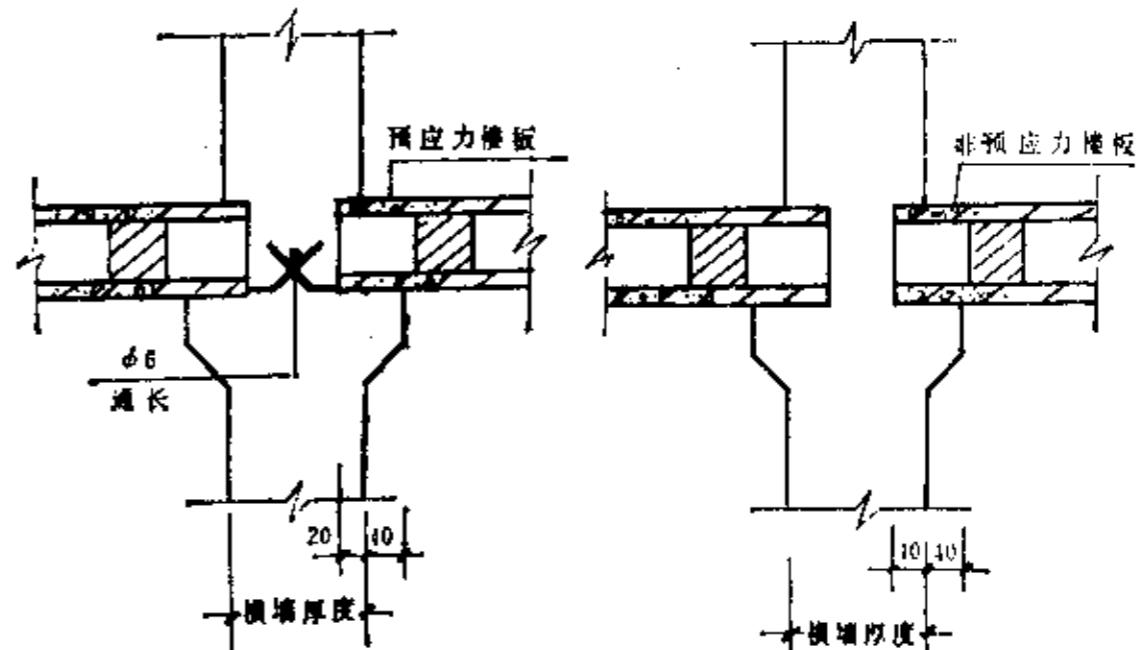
预应力楼板搭接构造图 图 5.0.10-2 非预应力楼板搭接构造图
